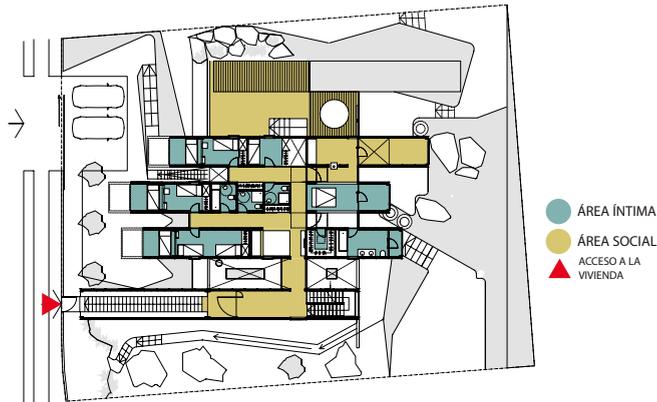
Casa Oruga/Distribución espacial/Planta Baja.
